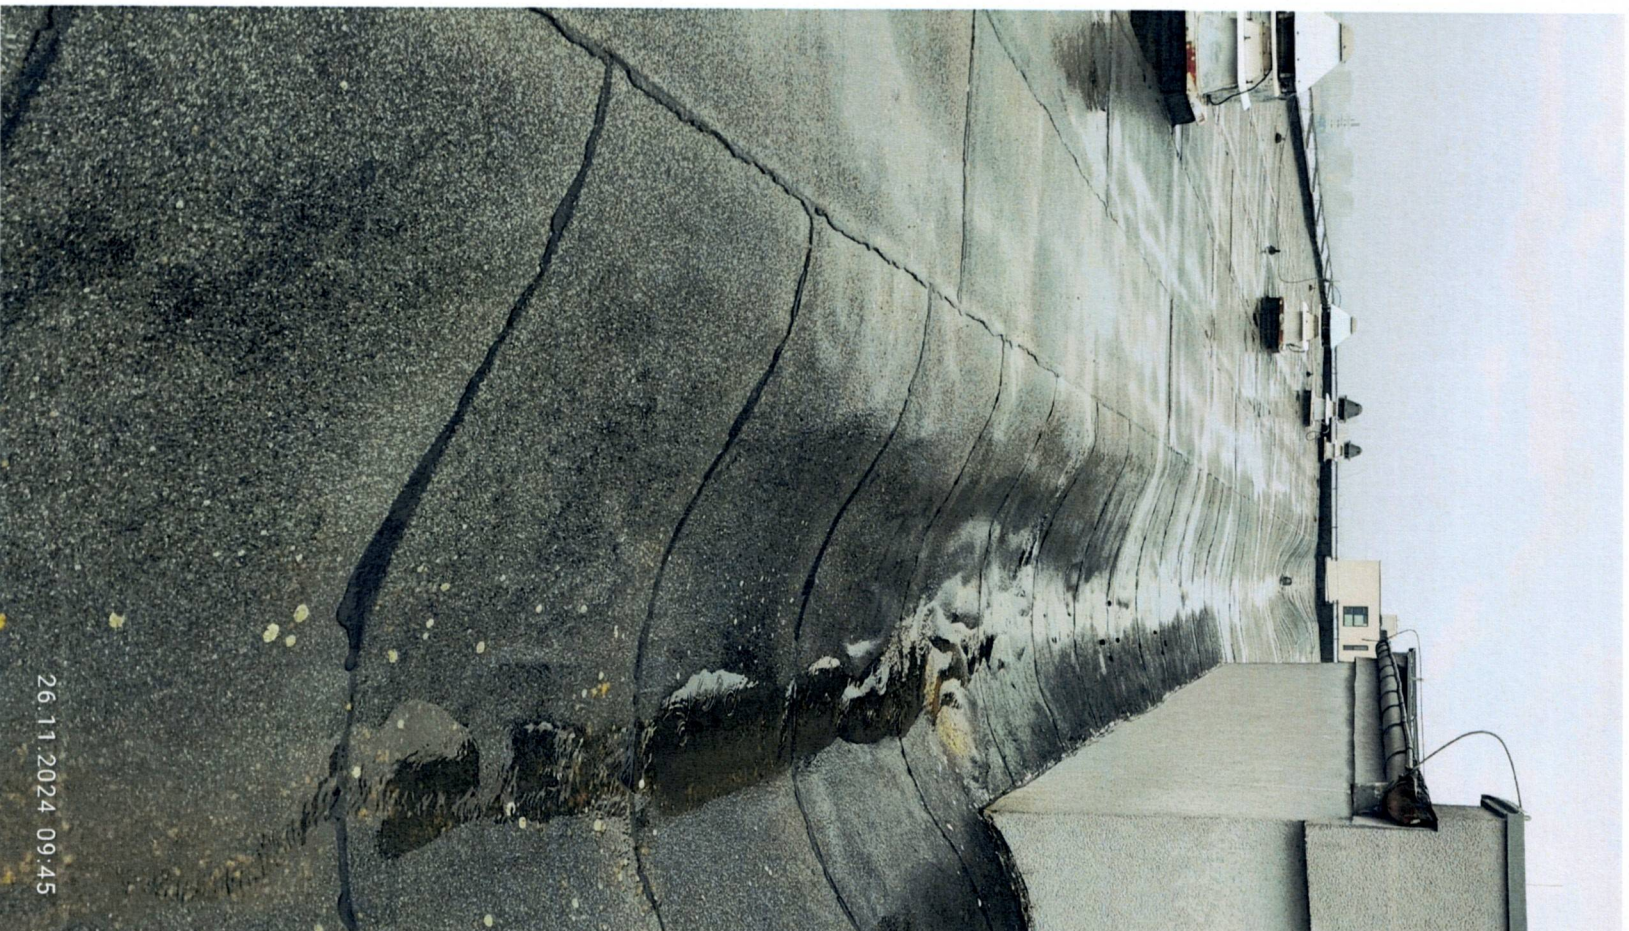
Widok dachu budynku (stan pokrycia oraz wyposażenie dachu)
